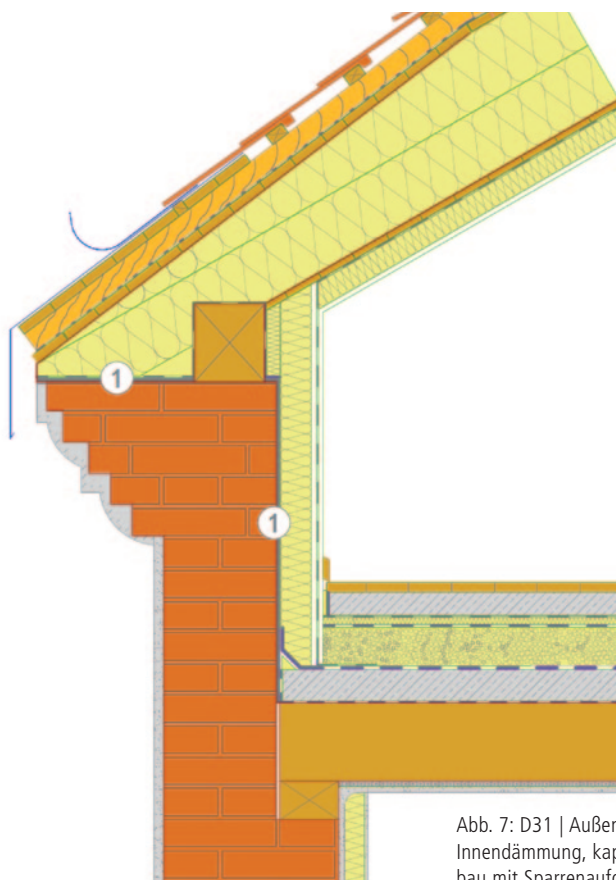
D31 | Außenwand Vollziegel mit Innendämmung, kapillarleitfähig – Dachausbau mit Sparrenaufdopplung (Buch Seite 120)
